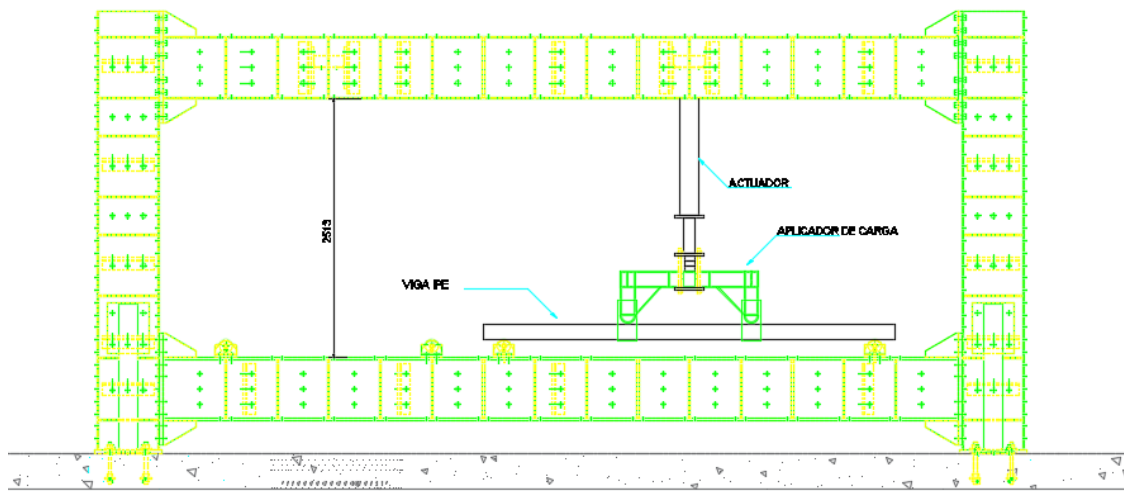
Plano de montaje de actuador para ensayo a flexión viga HEA – Plano de pórtico tomado de Estahl Ingeniería con modificaciones propias
